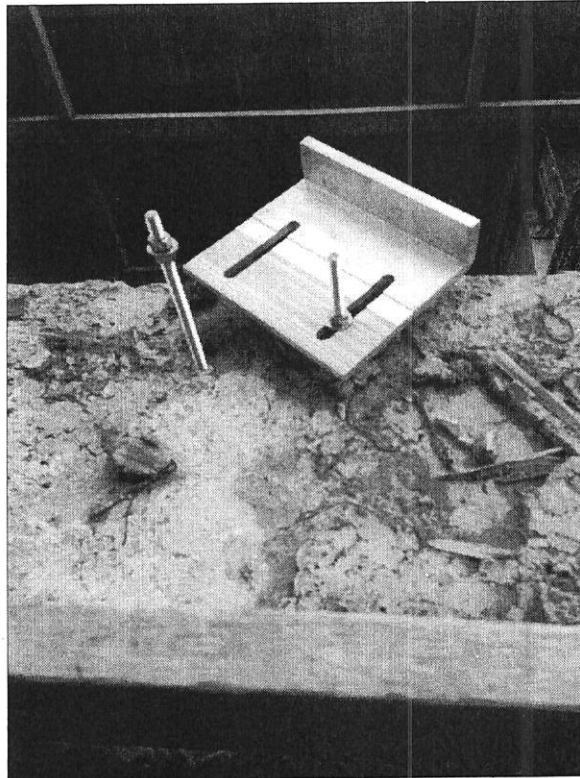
Insert* desconectado com o parafuso fixado à estrutura de concreto.
